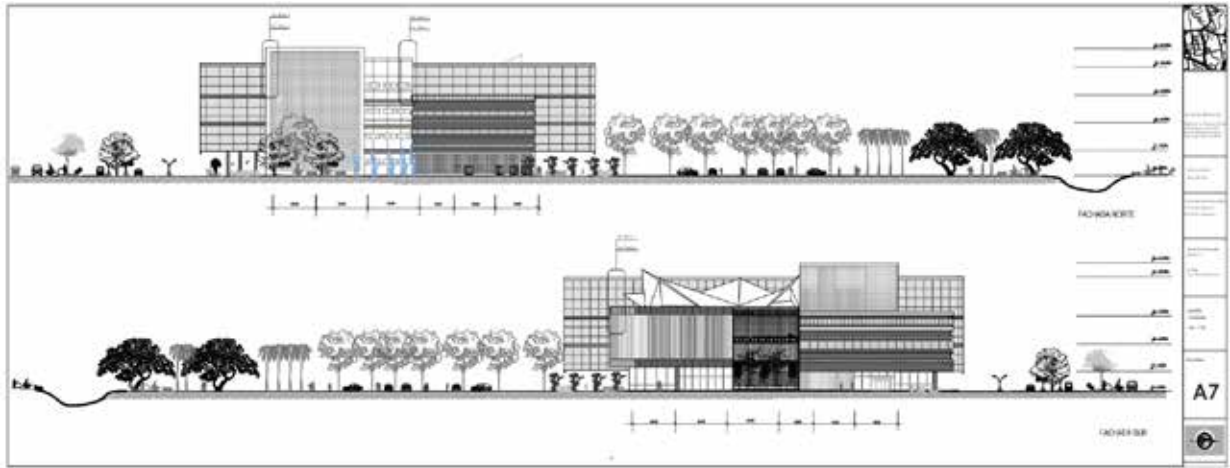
Fachada Norte y sur A-7. La Autora (2015)
